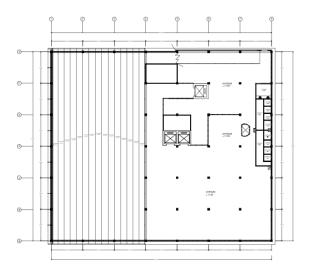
Denah Rencana Plafon Lantai 1 Sumber: dokumen pribadi
